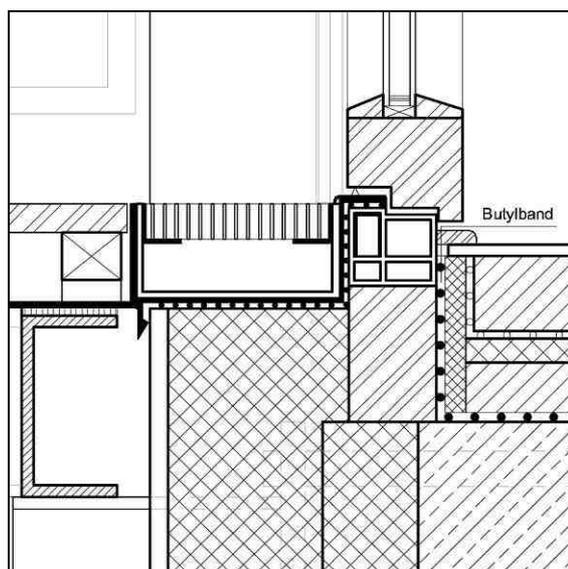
Detailschnitt Balkonschwelle
